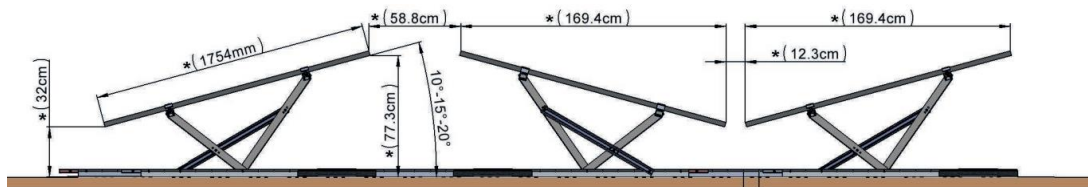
Proposition d'implantation sur toit végétalisé (source : contec)
